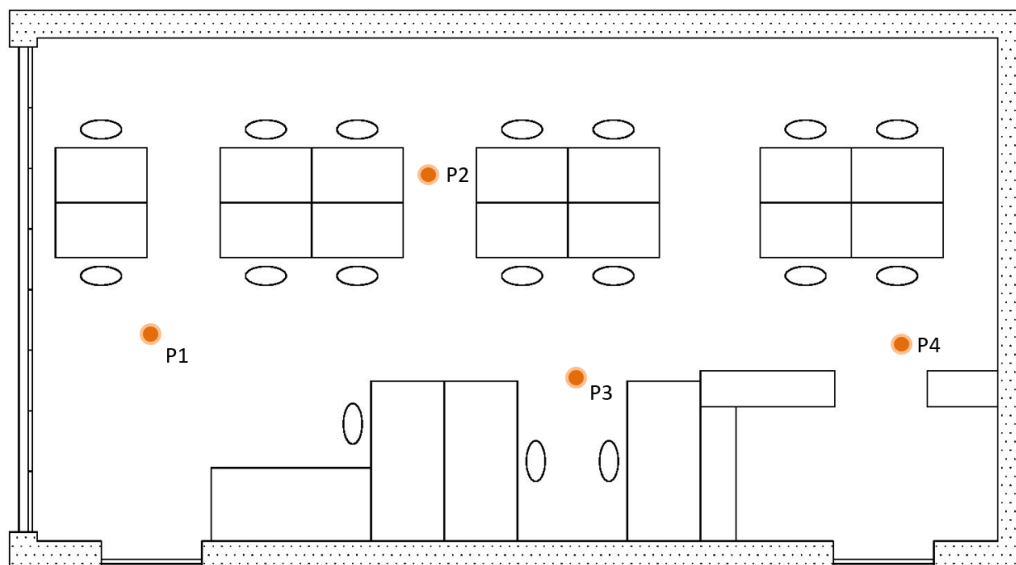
Esquema representativo da planta do open-space da Empresa C
